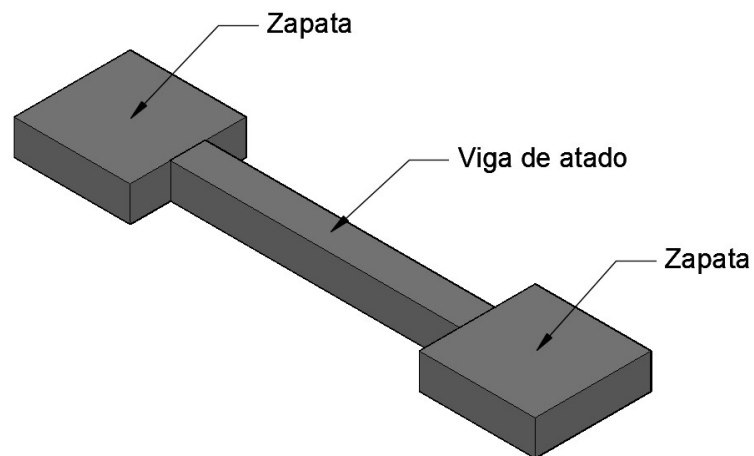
Gráfico 3D de zapatas unidas por una viga de atado
